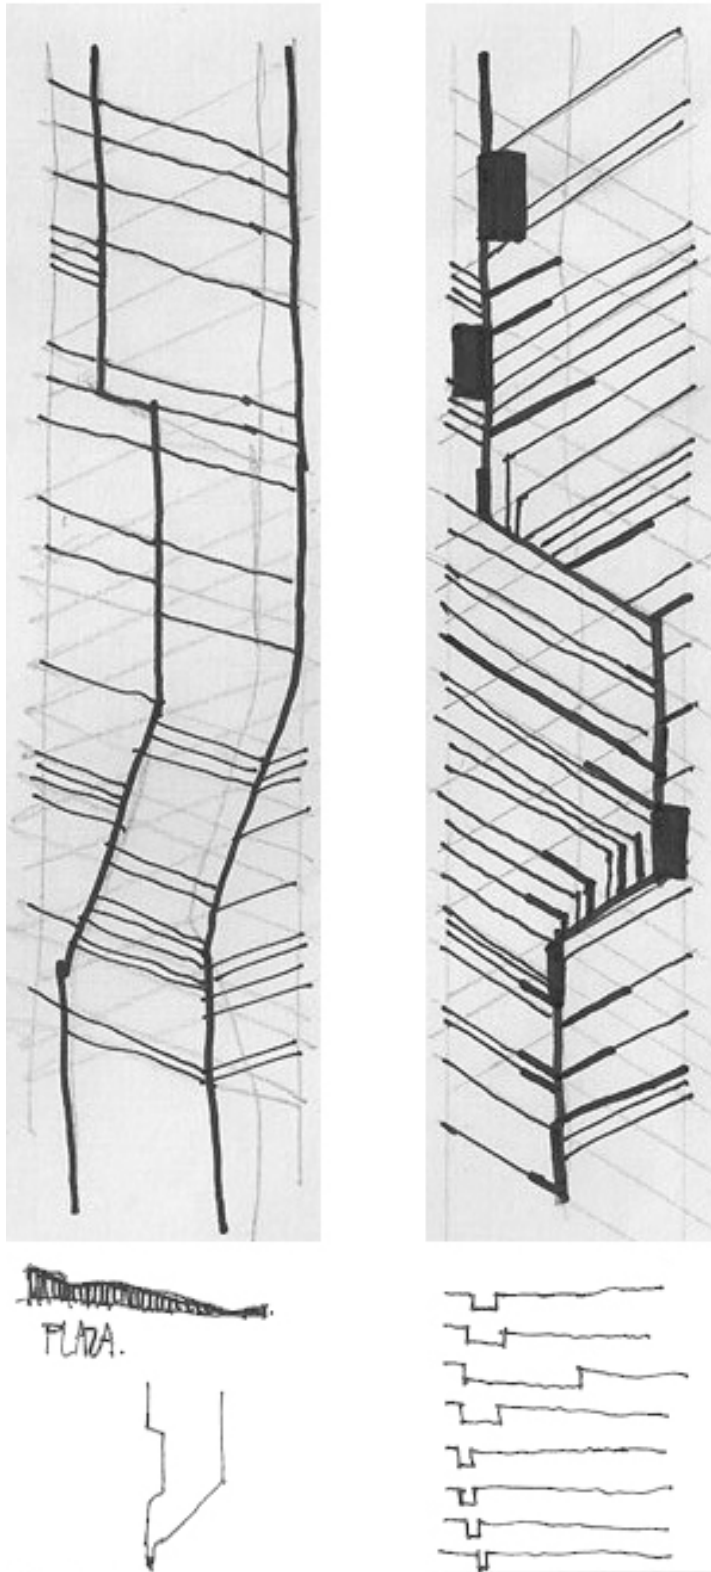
Croquis para propuesta de pavimento en Corredor Peatonal
